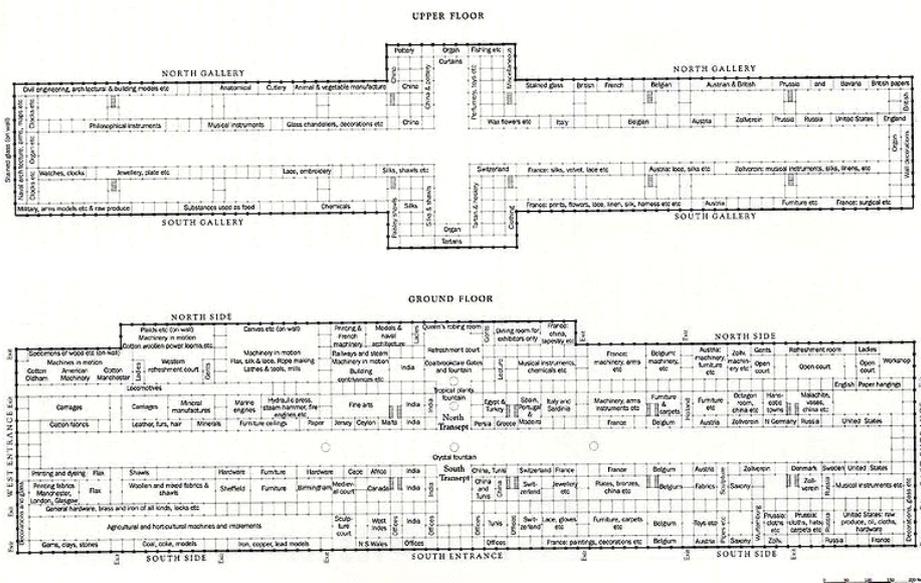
Planta contemporânea do Palácio de Cristal da Great Exhibition de 1851, Londres.
